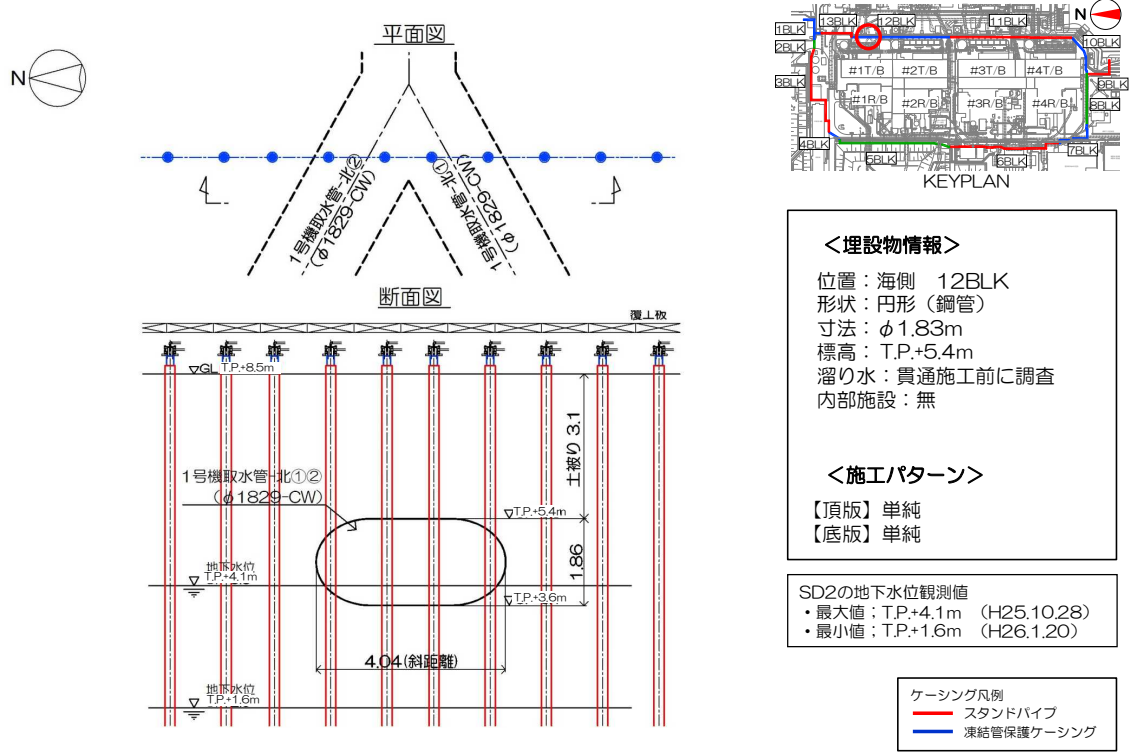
【12-9】1号機取水管-北①② 施工方法（貫通施工）
